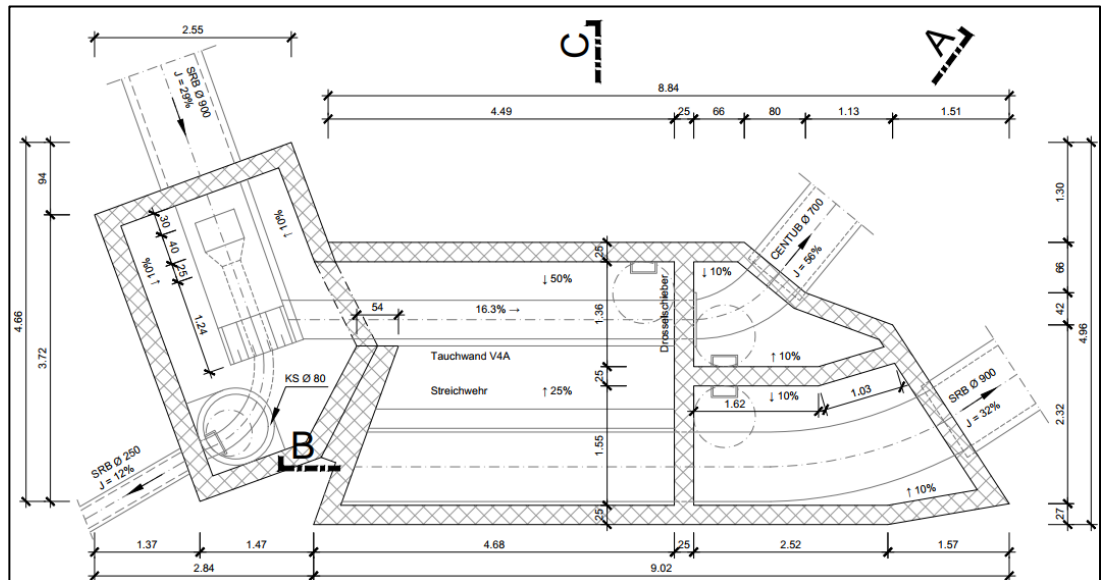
Grundriss RÜ Lauffohr
